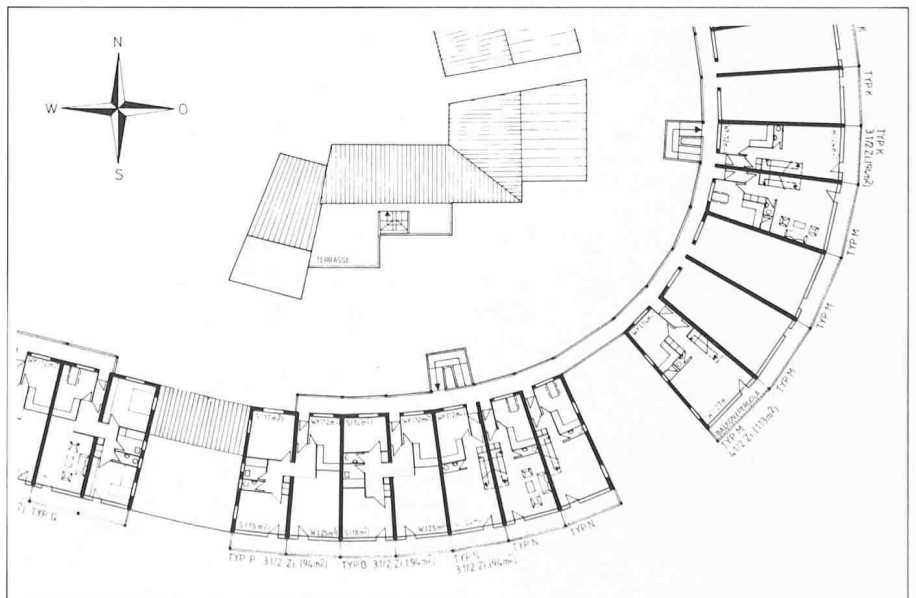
Ausschnitt 2. Obergeschoss Vorprojekt 1:200
